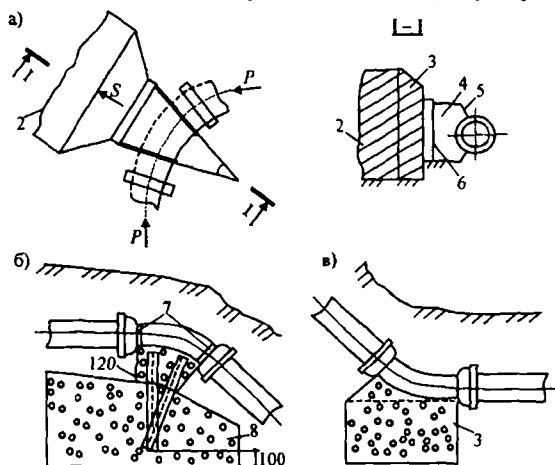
Упоры для чугунных подземных раструбных трубопроводов:
